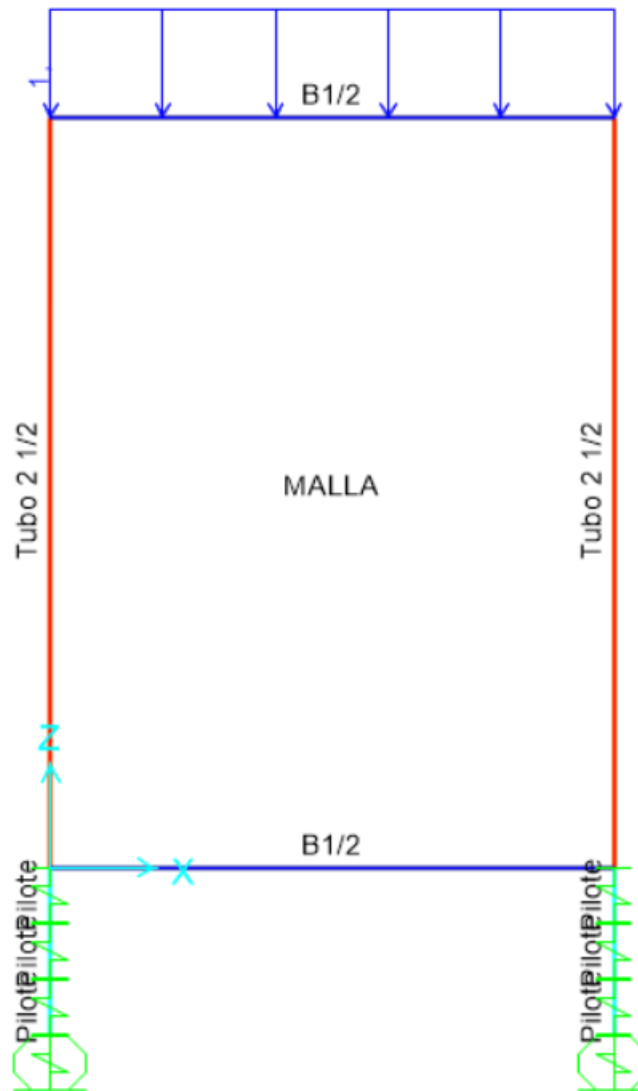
Frame Span Loads (L) (GLOBAL CSys) [Kgf, m, C]
